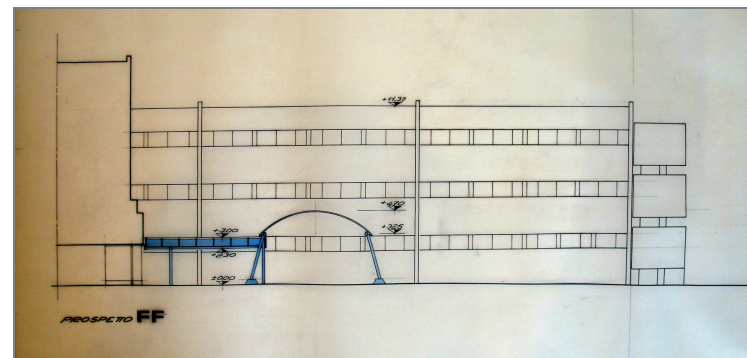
prospetto nord ovest corpo C (fonte CSAC – stralcio tav. 2, archivio n. 400-1)
